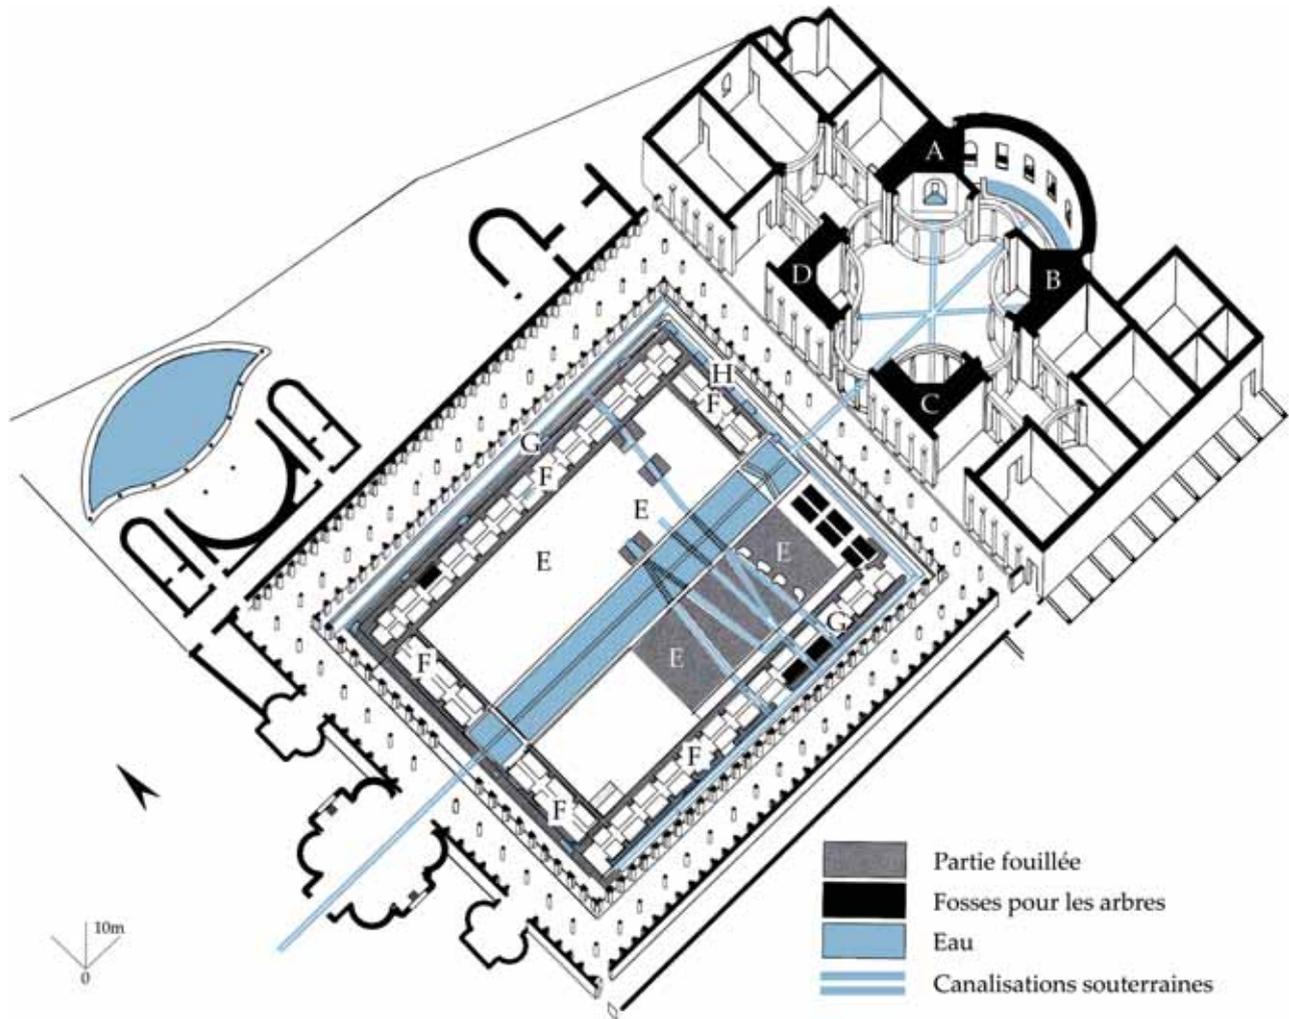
Villa Hadriana, Piazza d'Oro : plan des structures d'irrigation de la Piazza d'Oro (Salza Prina Ricotti 2001, fig. 123).
